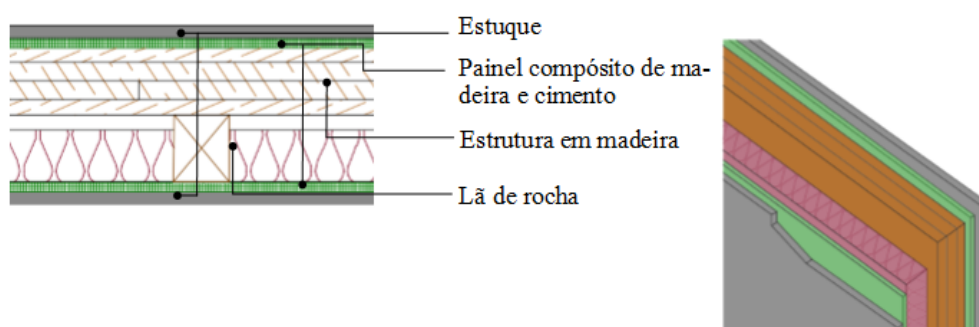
Esquema da solução 3 de parede interior (corte horizontal) e modelo em 3D
